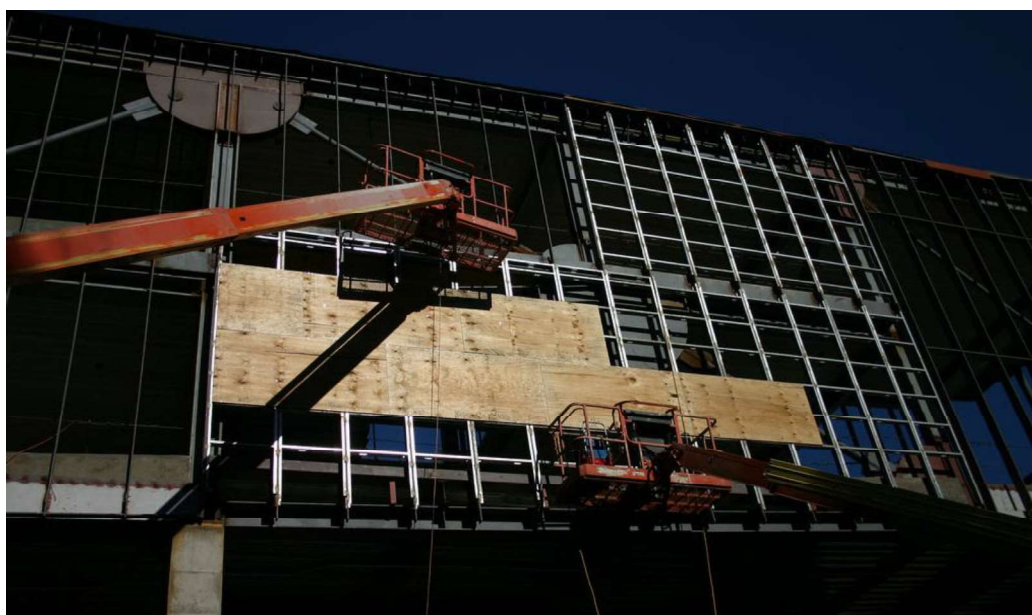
Montagem da fachada oeste e visualização da estrutura metálica. (Fonte: Flickr, 2013).
